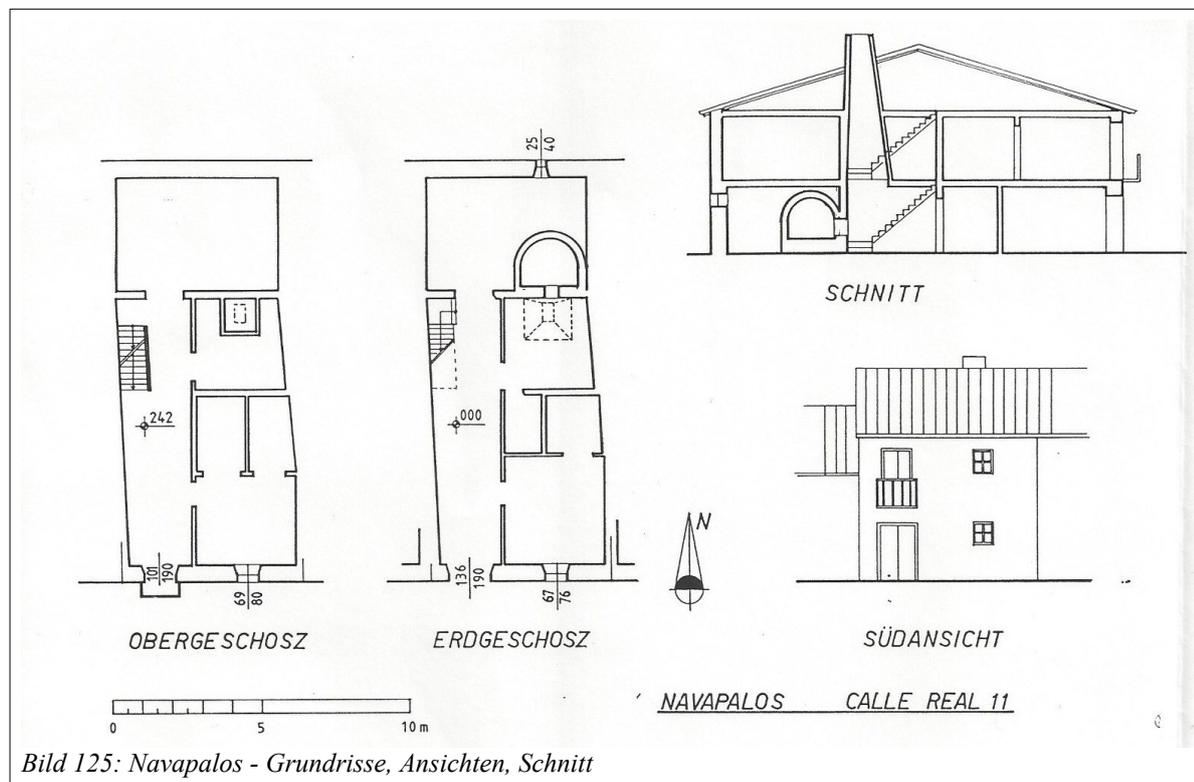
Navapalos - Grundrisse, Ansichten, Schnitt
